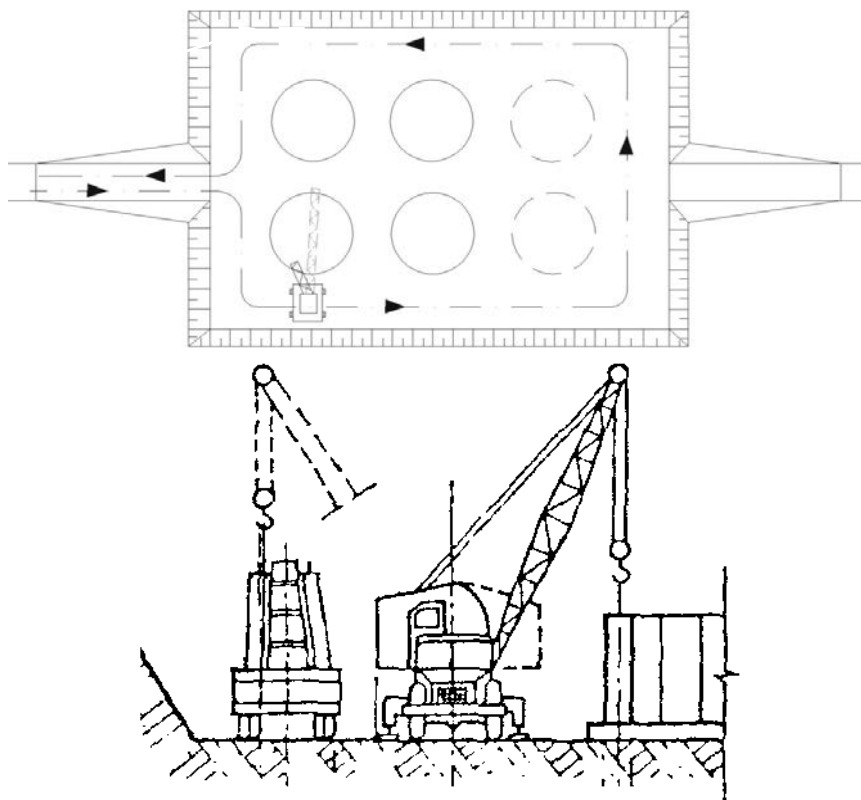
Кран расположен внутри котлована и перемещается по дну котлована вдоль монтируемых сооружений
